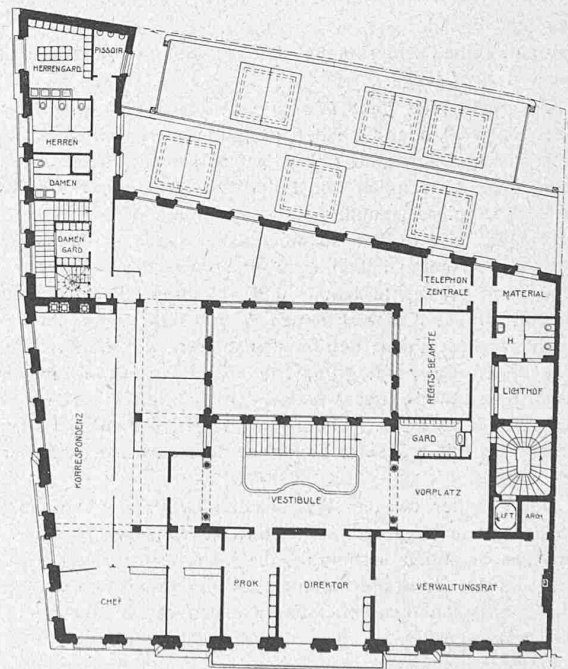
Schnitt, Abb. 4 Grundriss vom I. Stock, 1 : 400.
